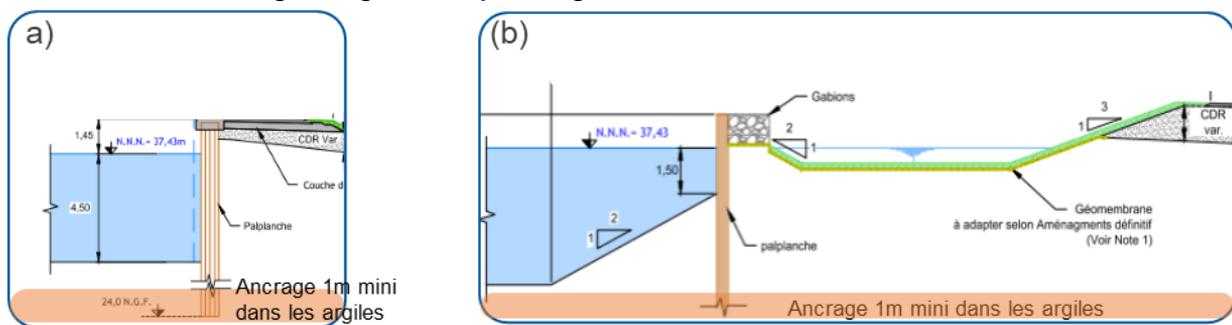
Coupe type d'une solution avec palplanche au droit de la zone verticalisée (a) et au droit d'une berge lagunée (b)
